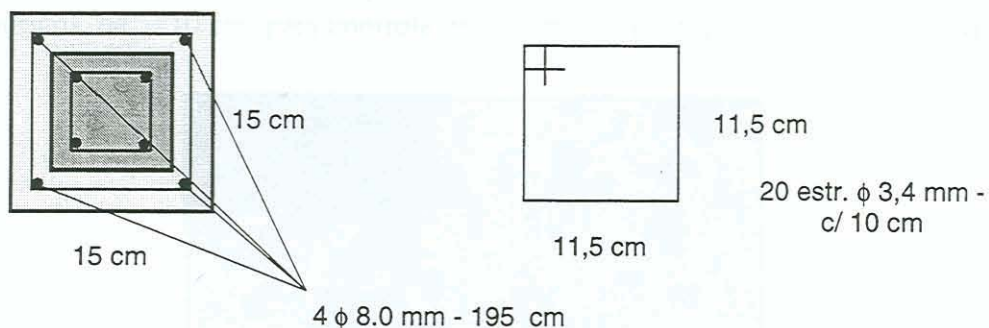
Seção transversal do pilar reforçado e armadura adicional.
